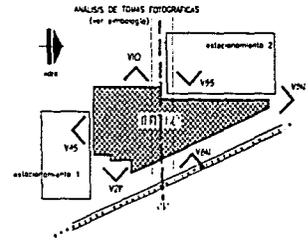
Plano superior: el terreno de la propuesta núm. 5
